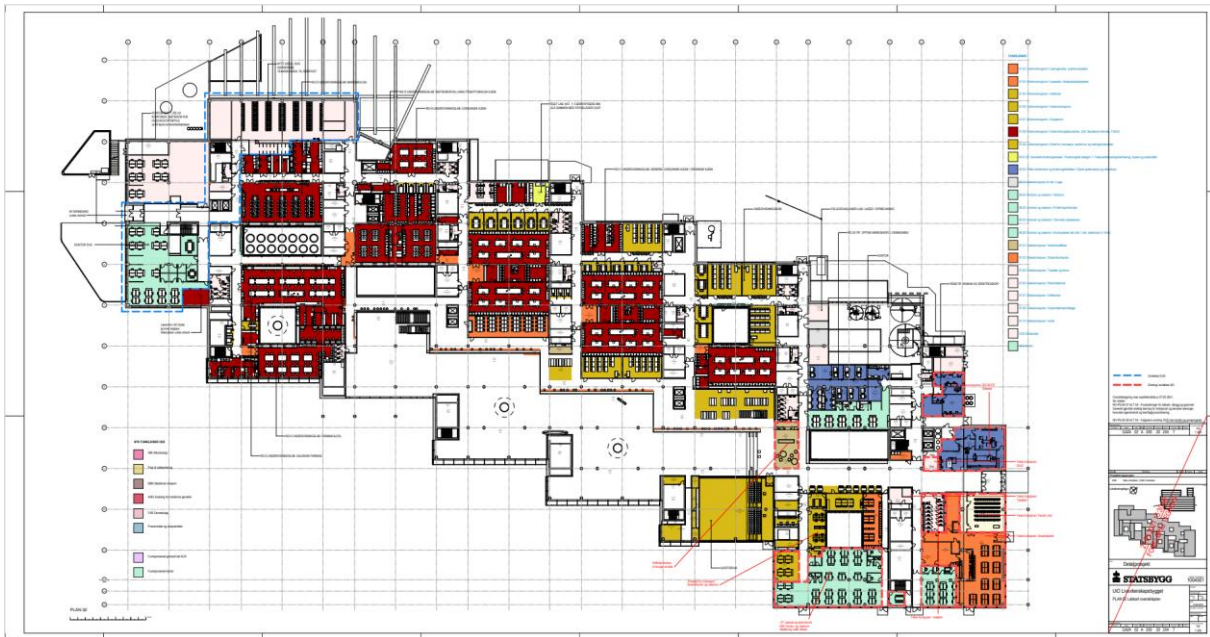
Innplassering av OUS sine funksjoner i plan 1
